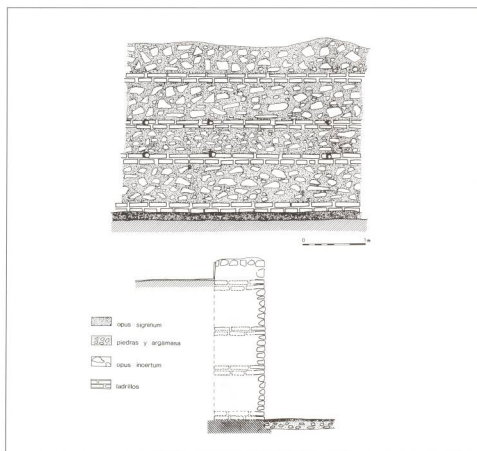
Munigua. Santuario. Alzado del muro externo en opus incertum, con hiladas de nivelación en ladrillo.
